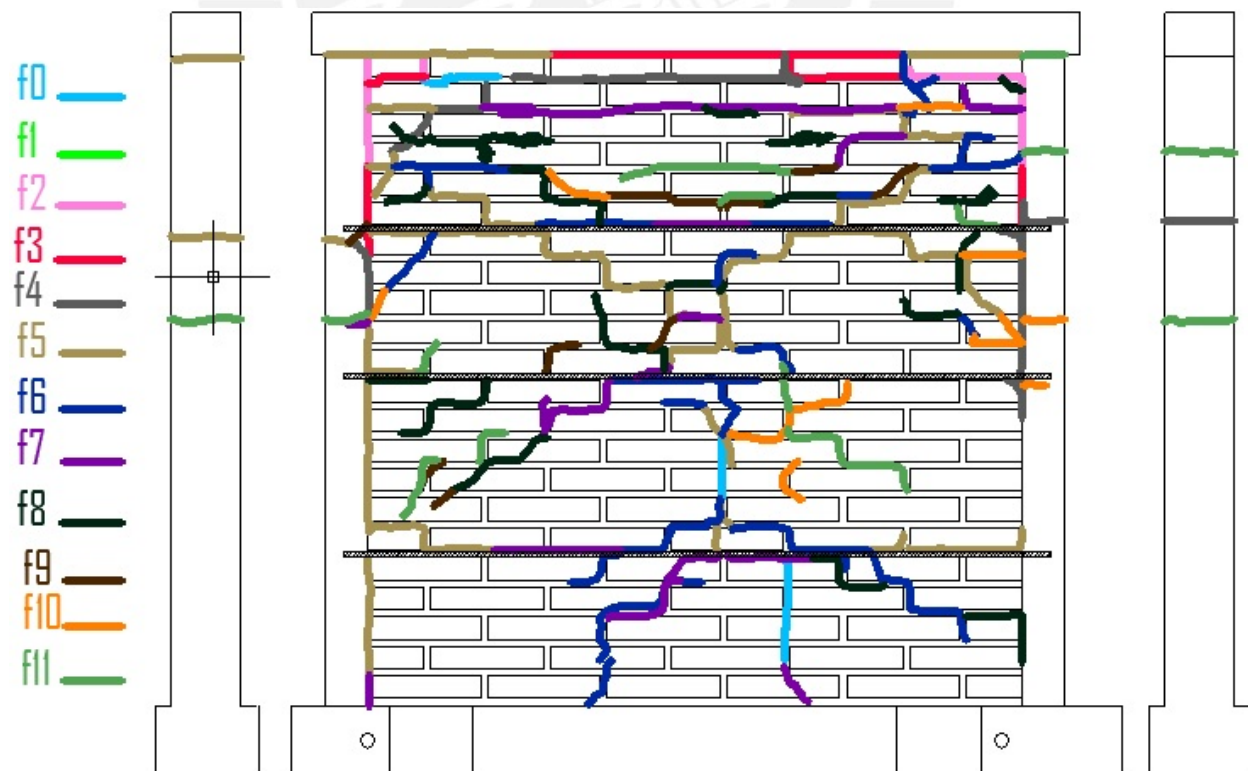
Diagrama de fisuras por fase en el muro M2.
